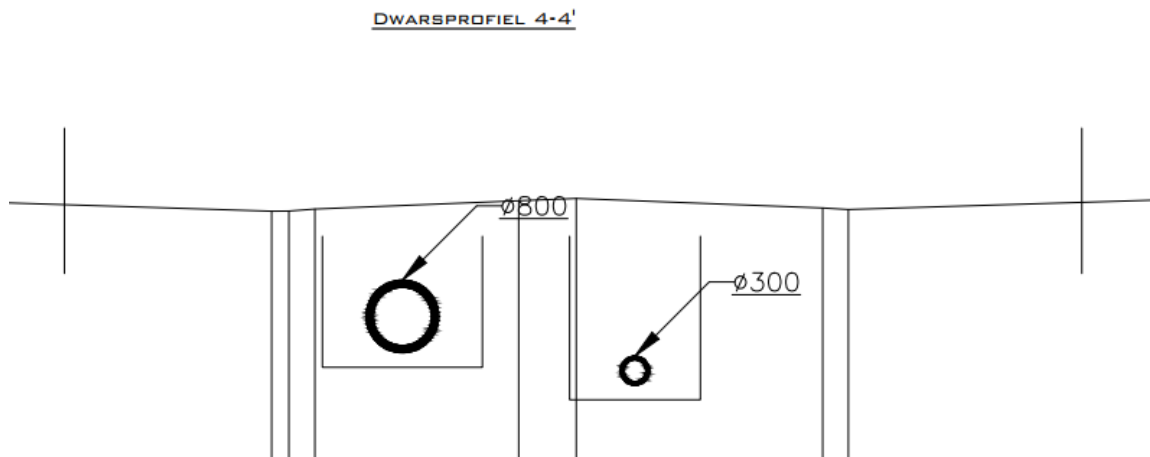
Uitsnede met bestaande toestand ter hoogte van het noordelijk deel van Industriepark-West
